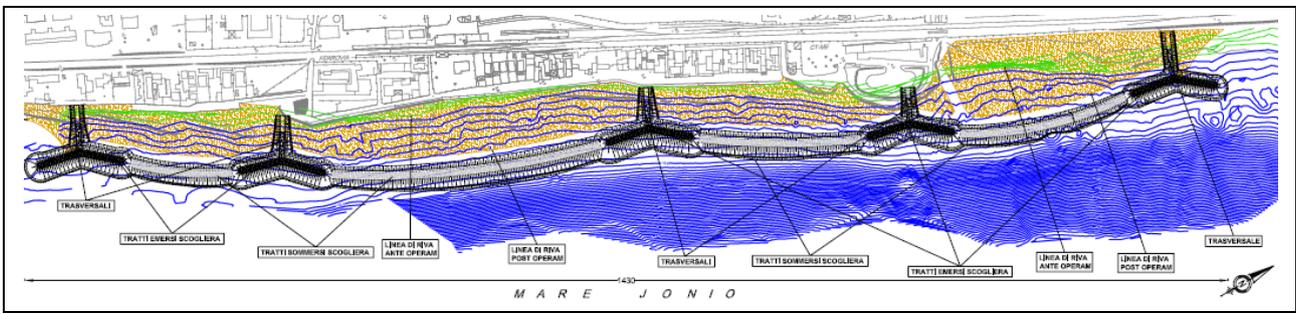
Planimetria di progetto del ripascimento protetto a Nord del porto esistente.
